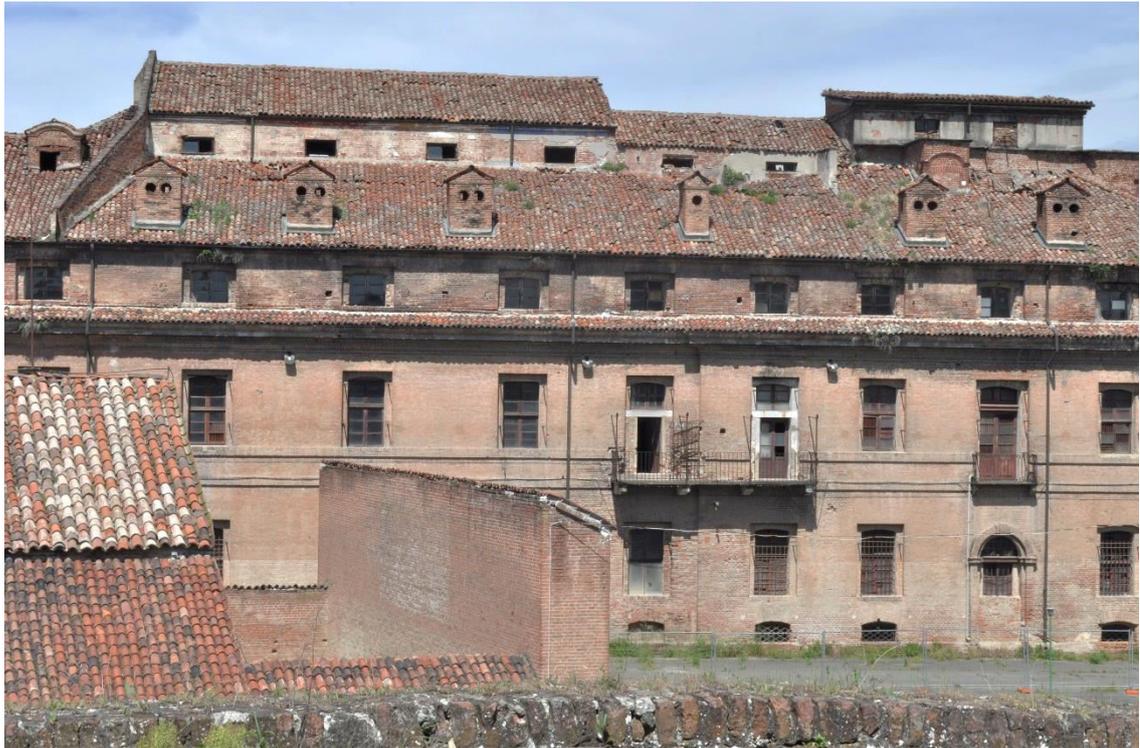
Manica Sud-Ovest. Sopraelevazione del secondo lotto dell'edificio: si legge in prospetto la diversa tessitura e cromia del paramento murario del piano attico rispetto al resto dell'edificio.
